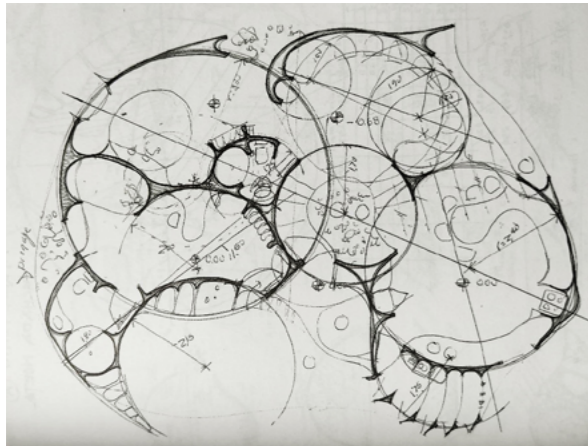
Dibujo a mano alzada - Planta vivienda
